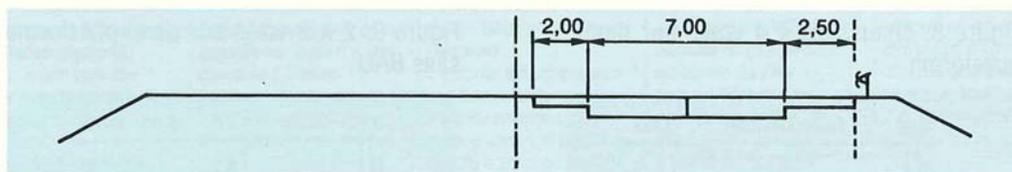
une chaussée de 7,00 m sur demi-plateforme
